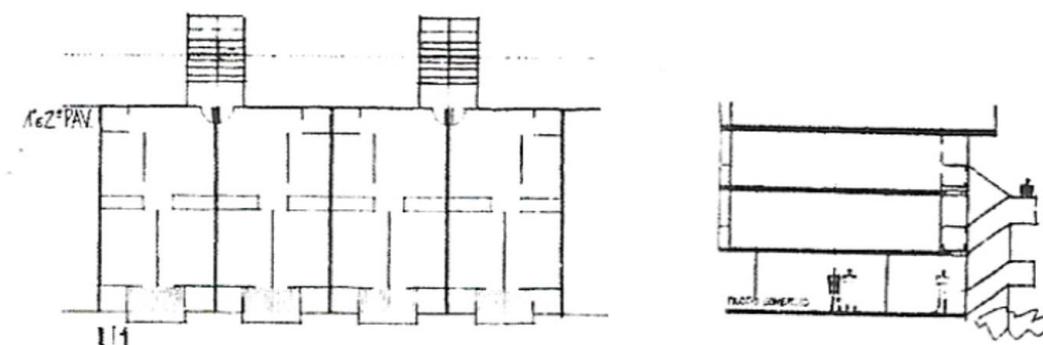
Planta baixa e corte. Estudo circulação para primeiro e segundo pavimento.
